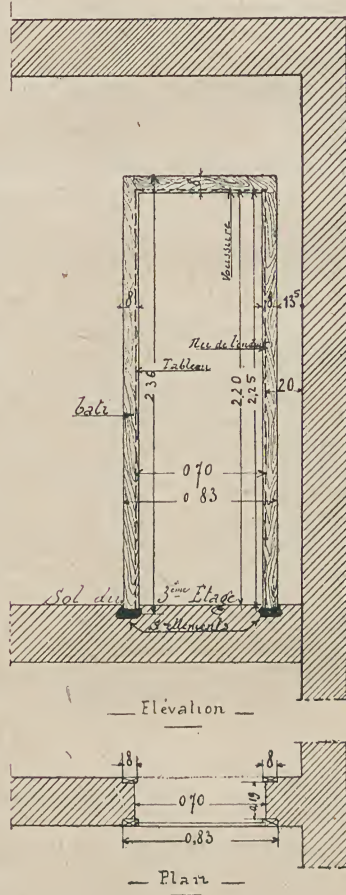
Élévation et plan d'une porte avec bâti et contre-bâti.
